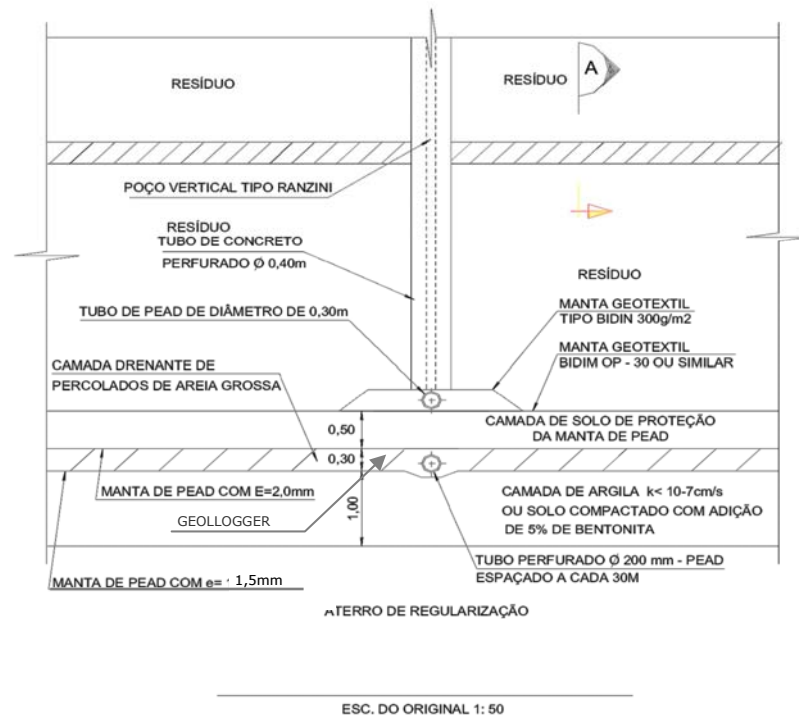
Sistema de impermeabilização proposta para as células dos aterros RSU e Industrial Classe II – CTR Santa Rosa.
